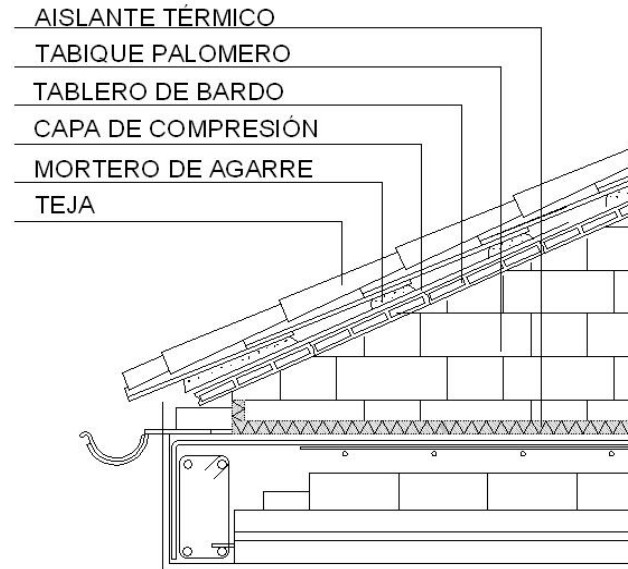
Detalle cubierta inclinada apoyada mediante tabiques palomeros
